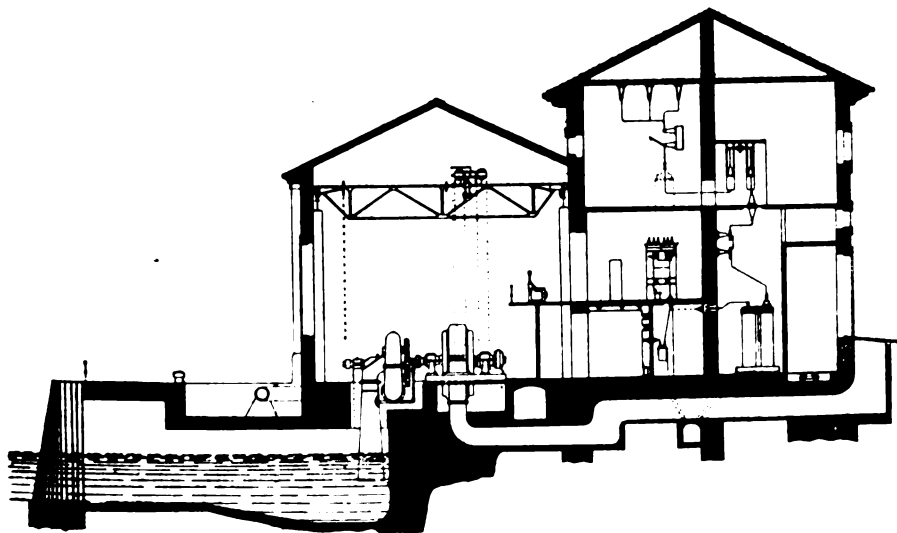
Coupe transversale du bâtiment de l'usine.
